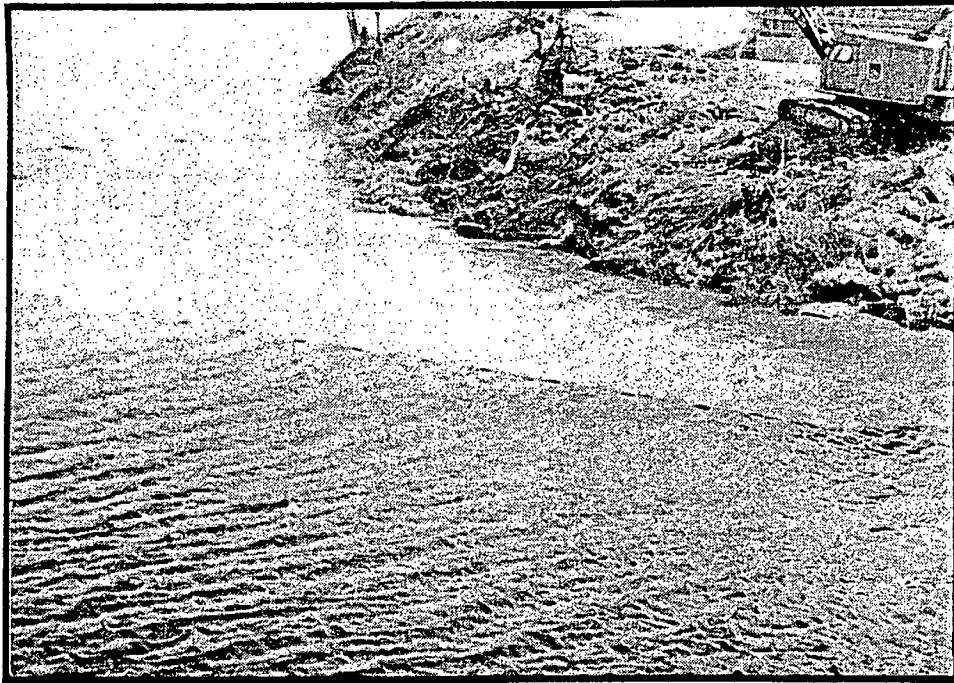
Les sédiments sont confinés à l'intérieur de la zone délimitée par la barrière avant les travaux d'excavation pour la culée sud du pont
